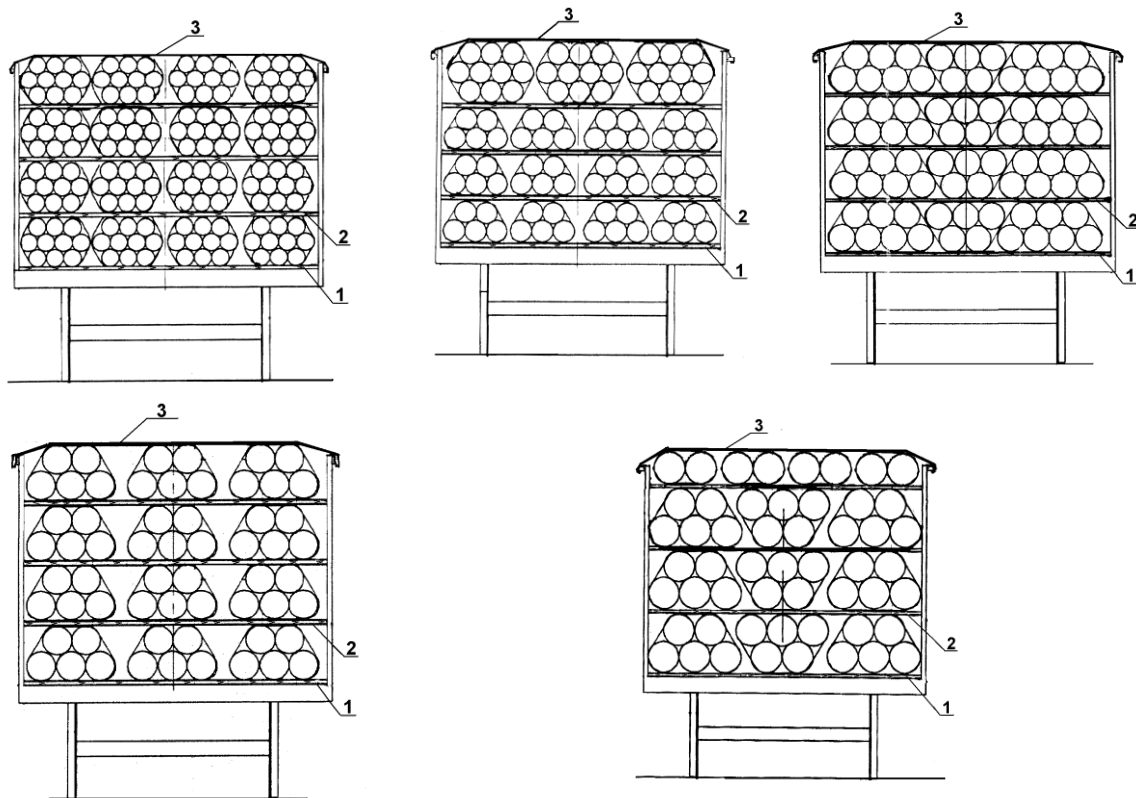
Варіанти розміщення пакетів труб: 1 - підкладка; 2 - прокладка; 3 - обв'язка
